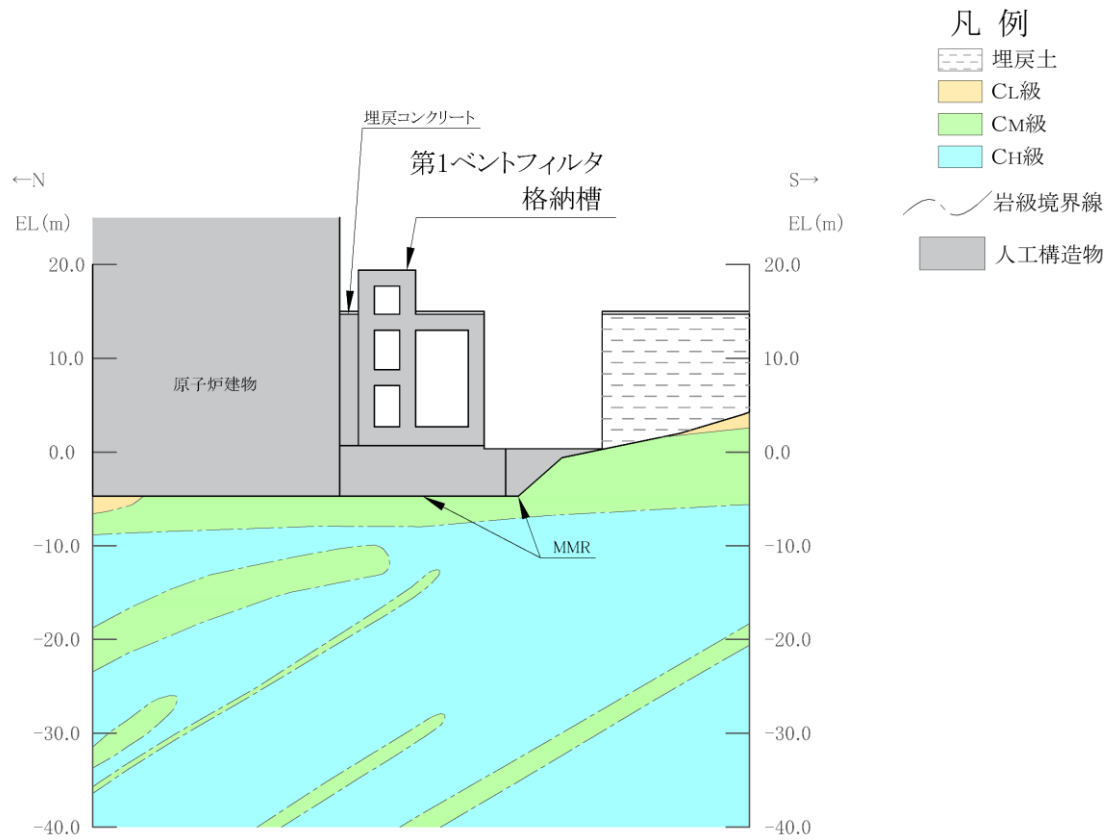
第 1 ベントフィルタ格納槽 評価対象断面図 (A-A断面位置)
